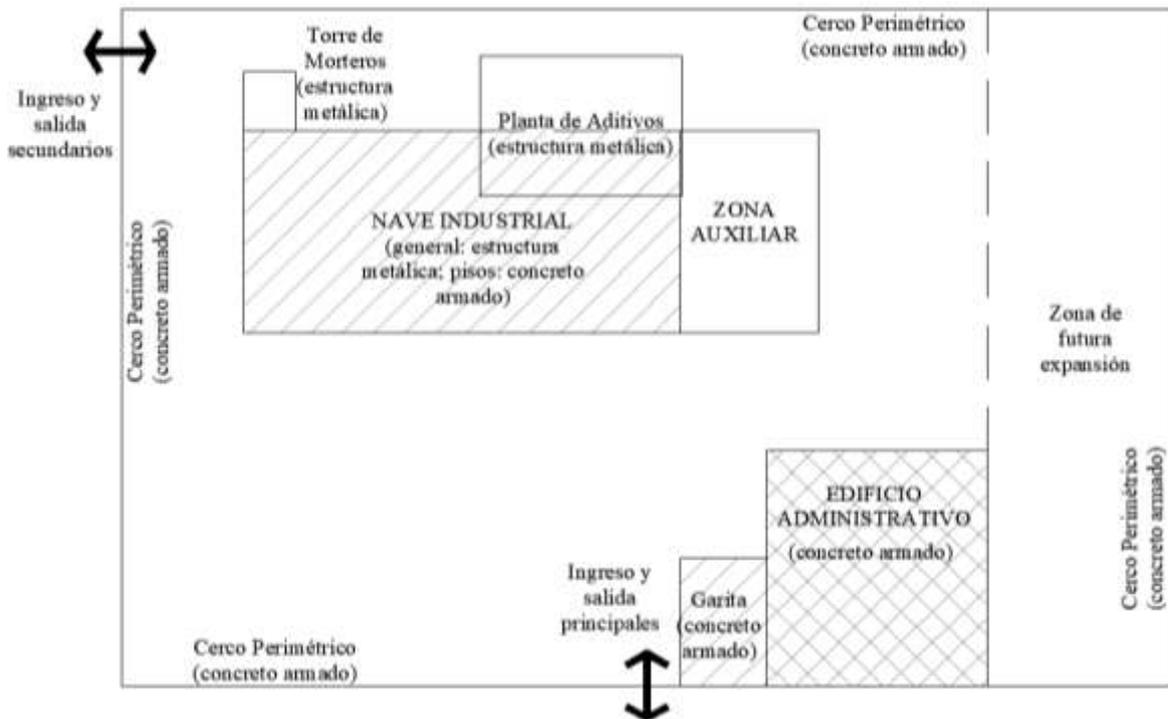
Tipología de Estructuras aplicadas en la Nueva Planta Industrial
